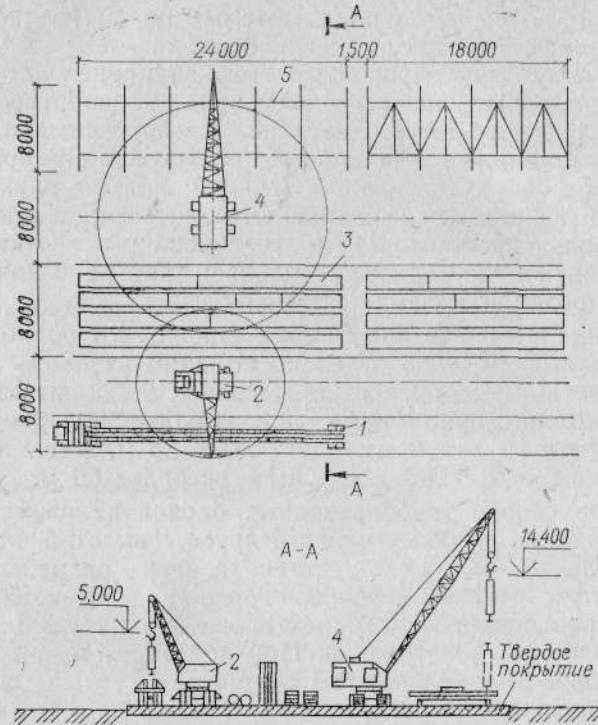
Схема стационарной площадки для сборки комбинированных блоков металлических ферменных эстакад
